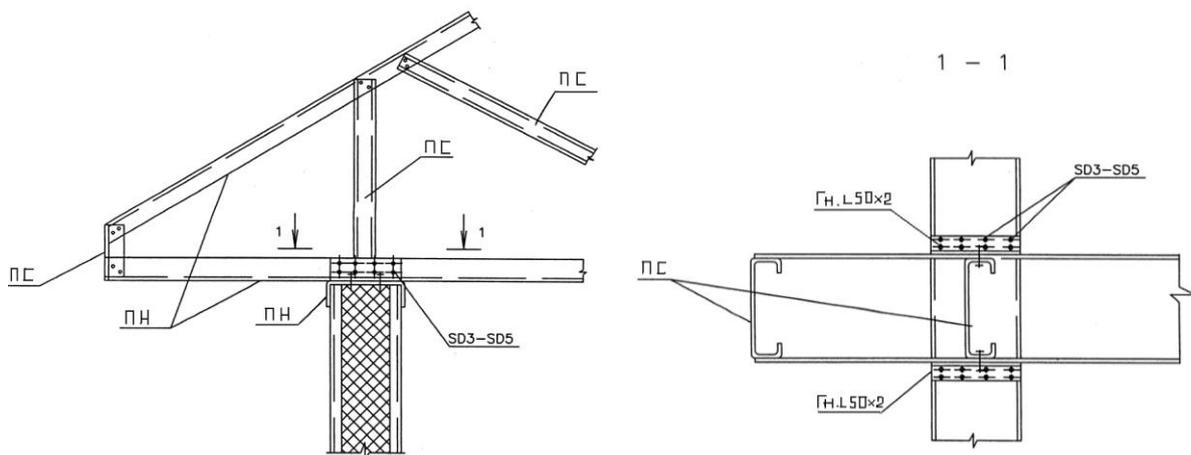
Опирание балок (ферм) на стены со стальным каркасом через направляющие
